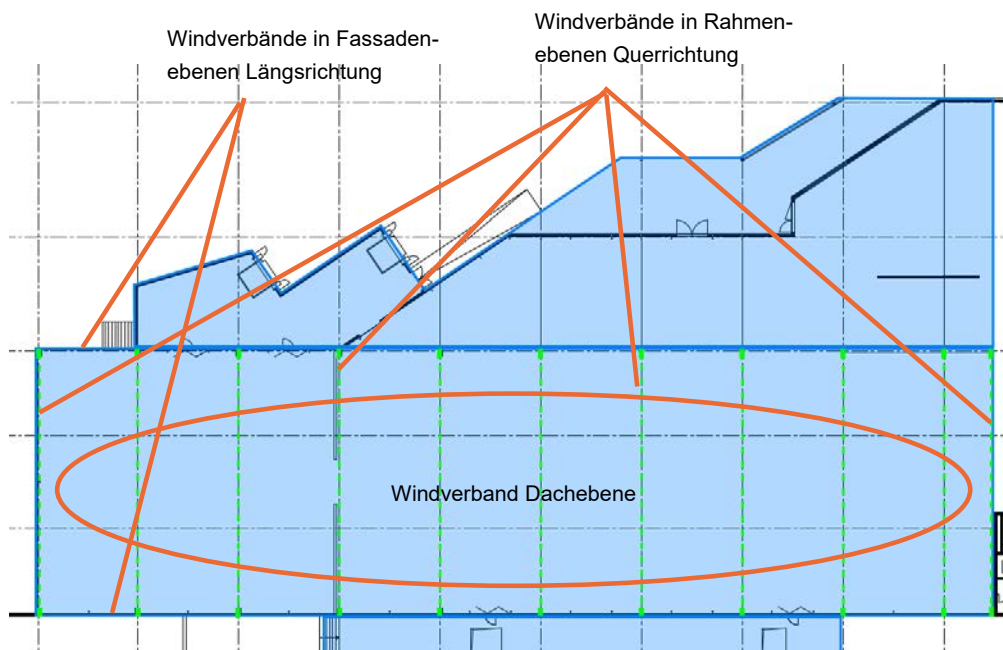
Grundriss EG Lagerhalle: mögliche Massnahmen am Tragwerk
